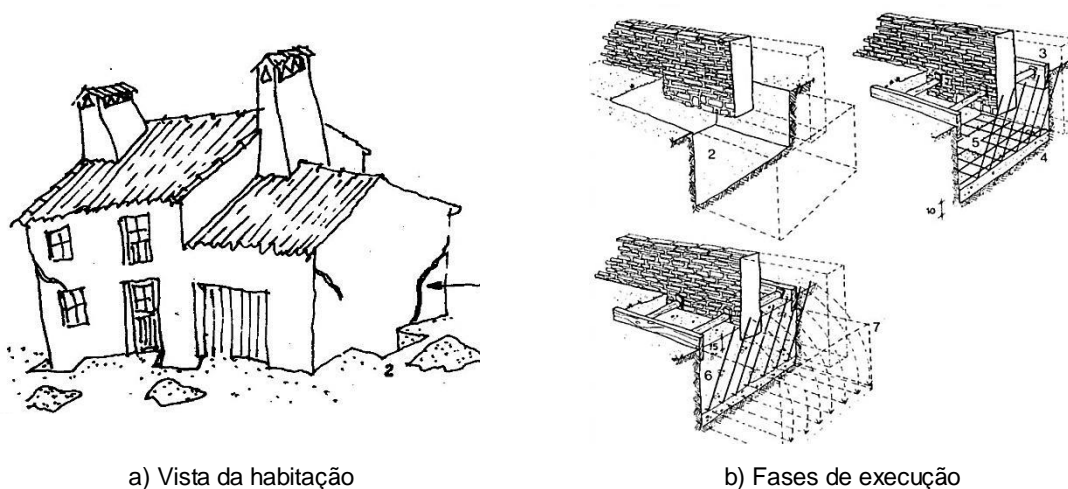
Reforço de fundação com valas de recalçamento em betão
